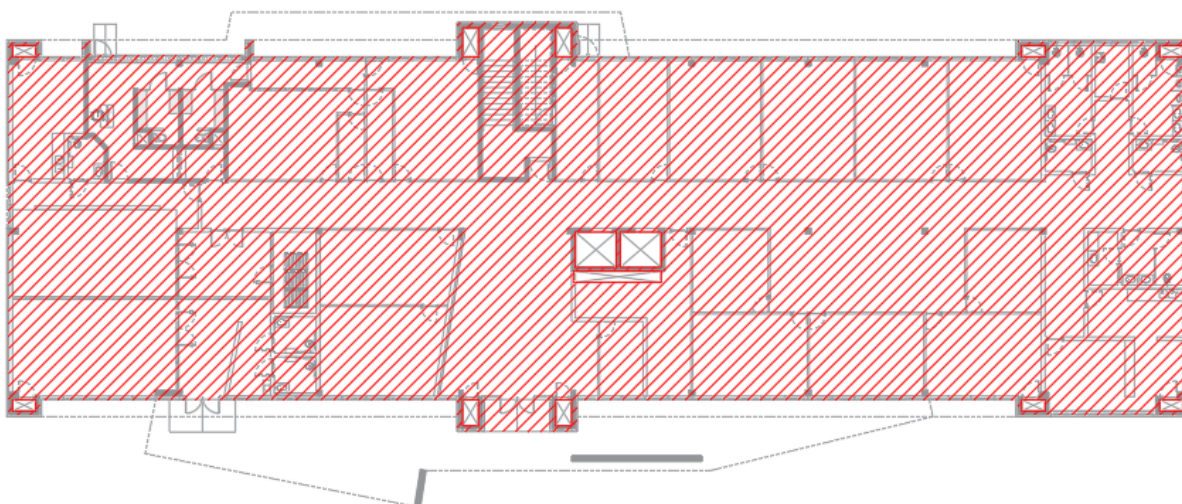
Áreas consideradas para o pavimento em contato com a fundação (Térreo)
